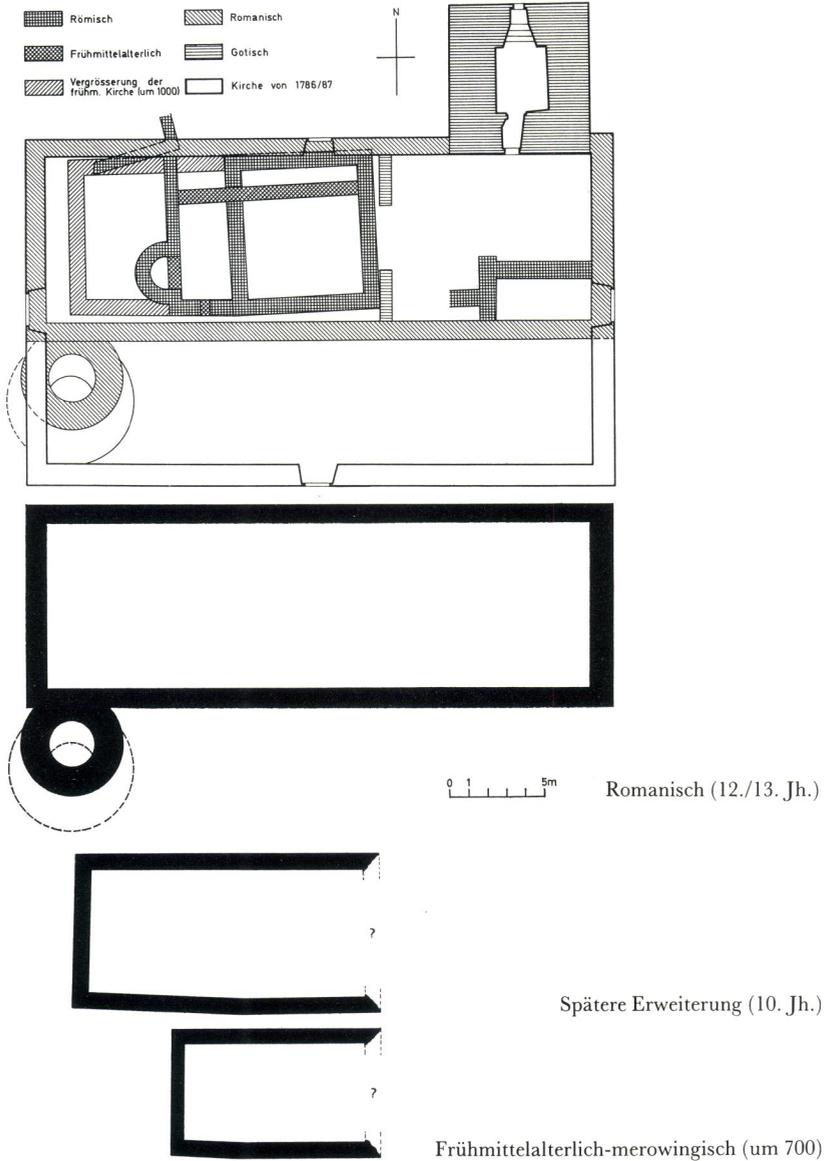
Hinwil. Ref. Kirche. Bauetappenplan mit den Grundrissen der Vorgängerbauten.
